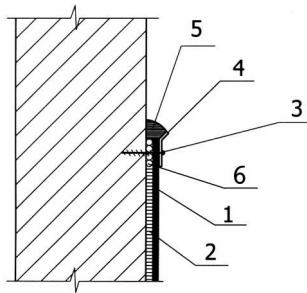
Примыкание кровли к парапету, стене с окончанием краевой рейкой
